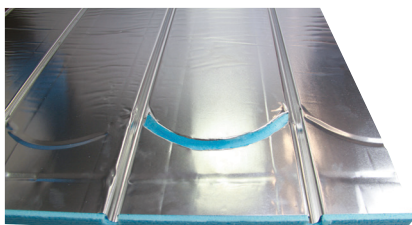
Alignez le coude de retour sur la canalisation droite du panneau
